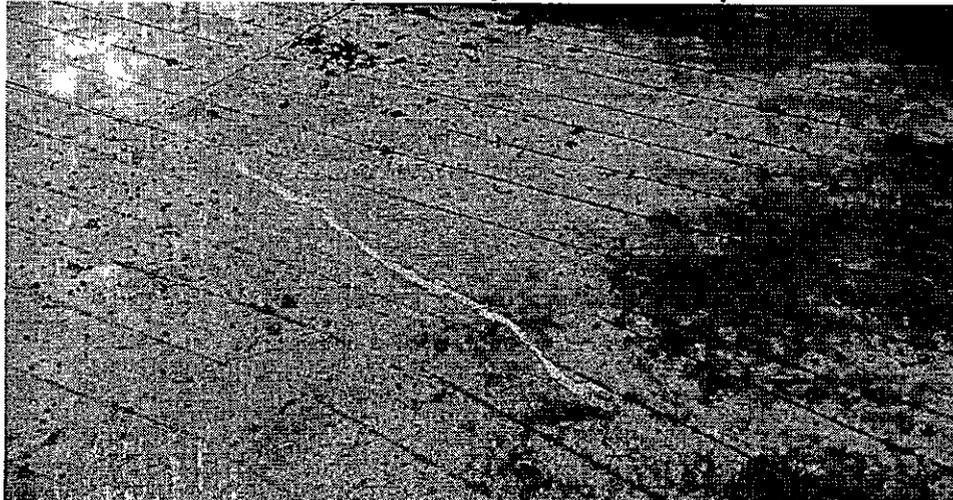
Cancha múltiple el campestre fisuras reparadas
